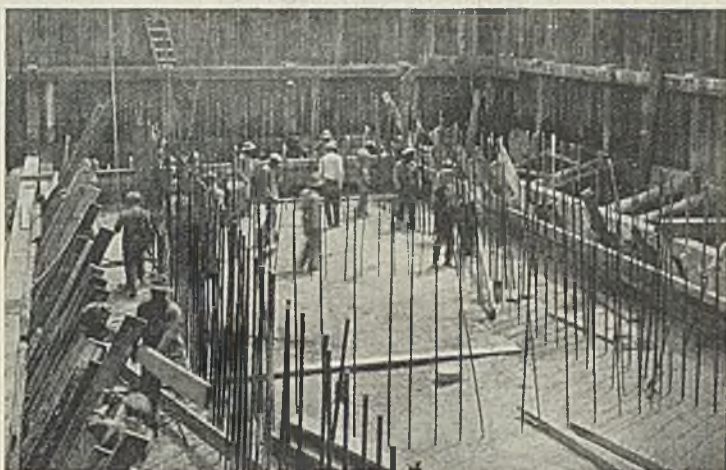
Gründung eines Brückenpfeilers unter Benutzung eines Spundwandfangedammes.
